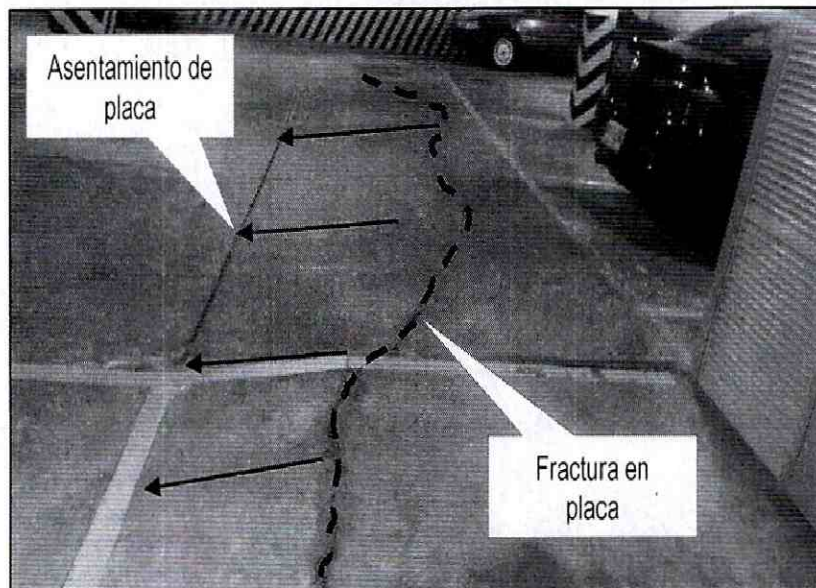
Grietas horizontales en el mezanine del local ubicado en el primer piso
